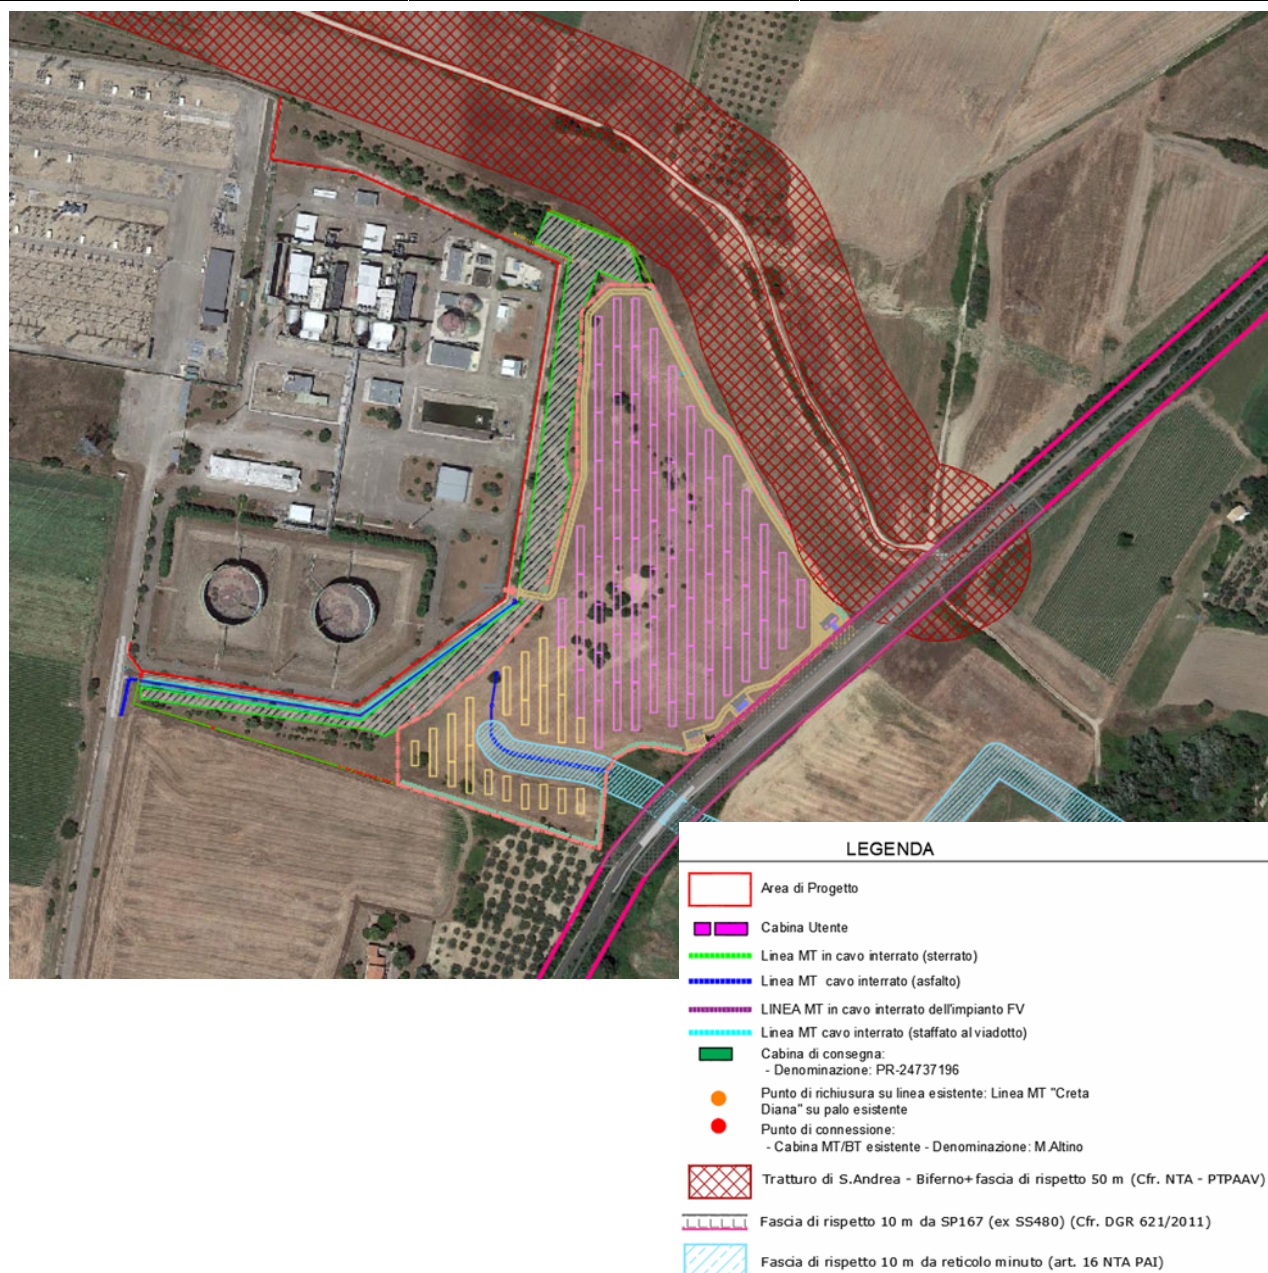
rappresentazione del layout rispetto ai vincoli e delle fasce di rispetto
